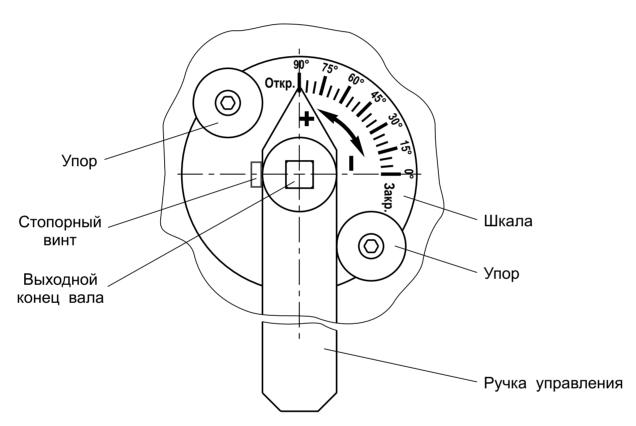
Заслонка регулирующая с ручным управлением (вид сверху)
